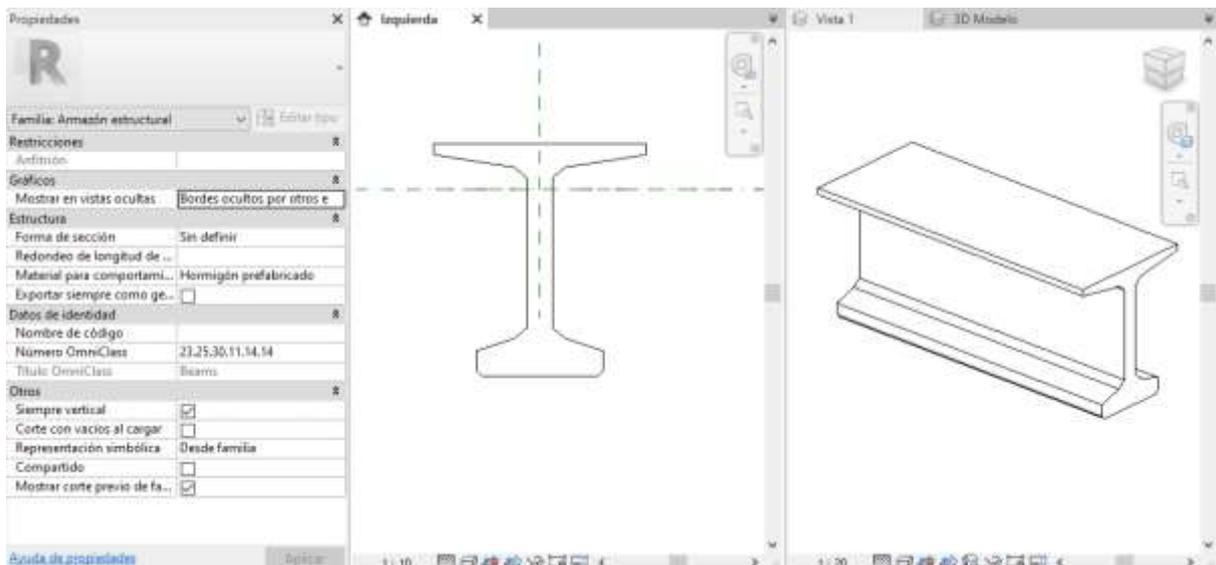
Apariencia final de la viga creada. Fuente: El. prop.
